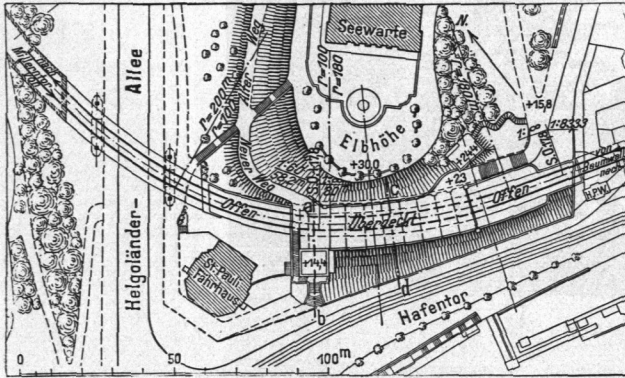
Haltestelle Landungsbrücken, Lageplan.
